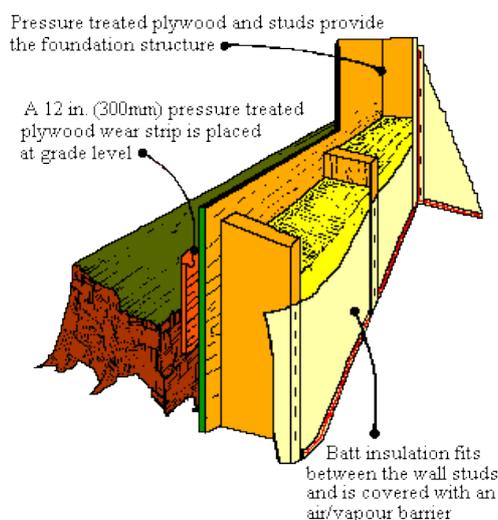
SYSTÈME DE FONDATION EN BOIS [WWW.FACULTY.IVYTECH.EDU]
